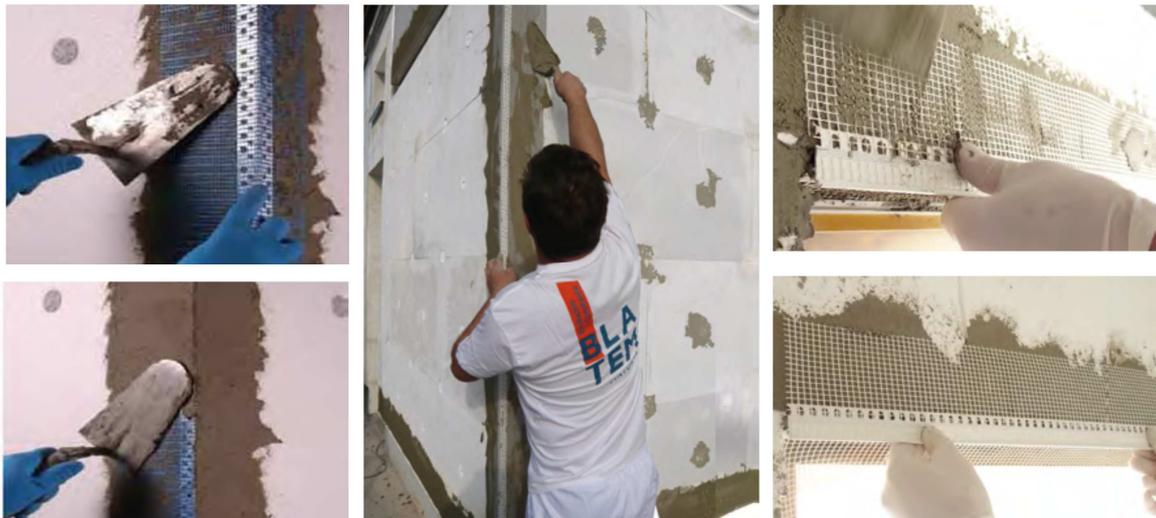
Aplicación primero de capa de mortero sobre placas aislantes seguida de otra mano de mortero para tapar el perfil en esquina y malla. Imagen 59. Colocación perfil goterón en dintel de huecos.
